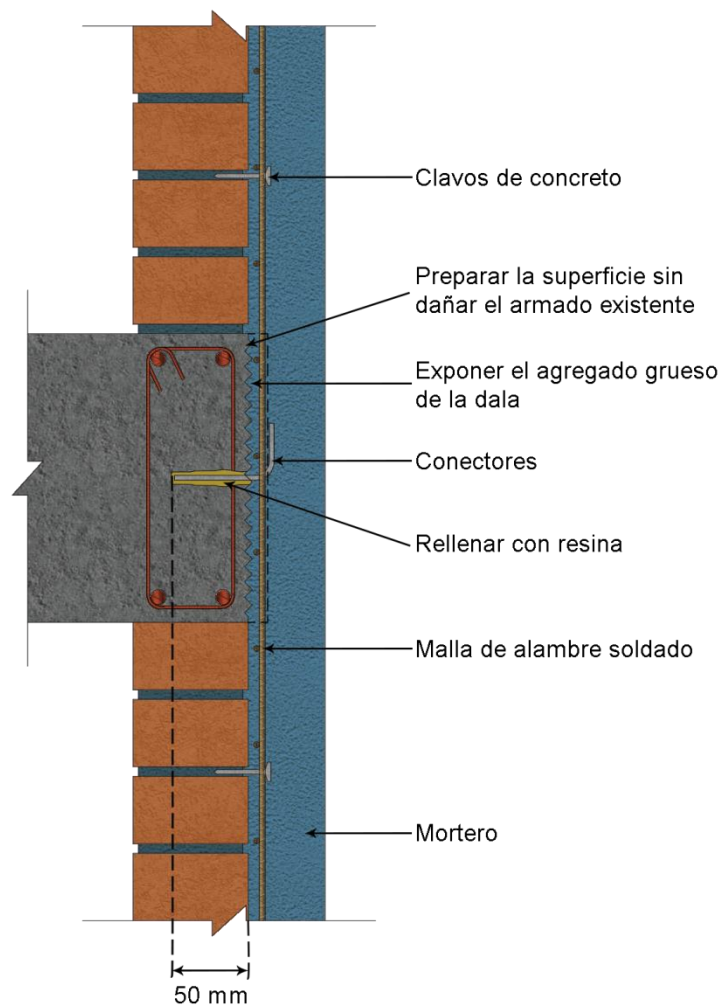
Detalle de la conexión del refuerzo del encamisado a dalas usando anclas a 90 grados.
